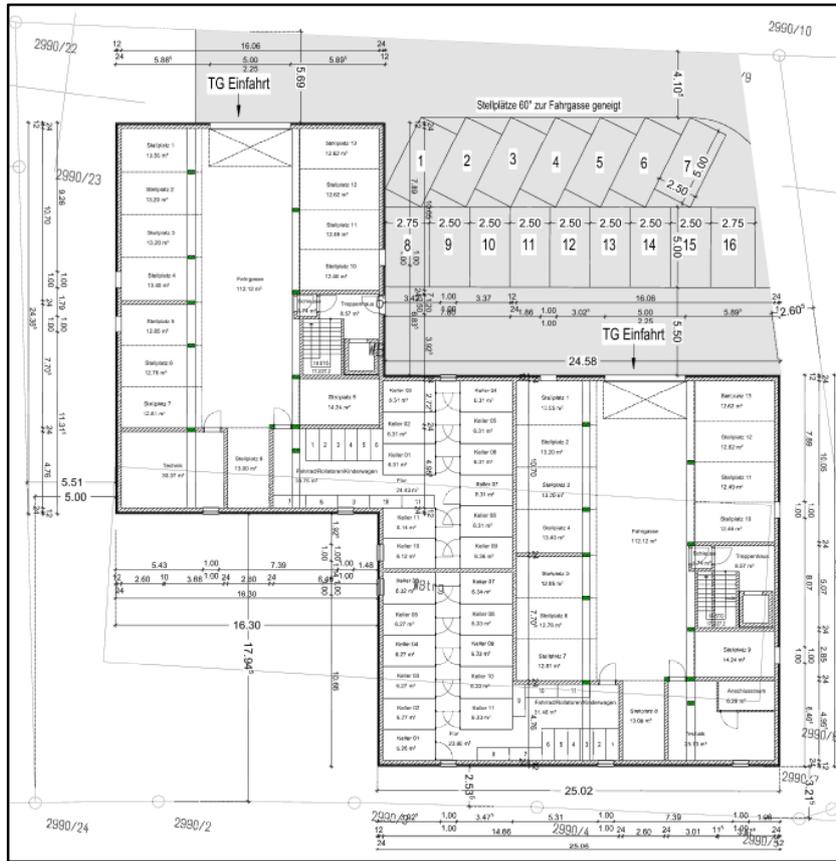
Planungskonzept Untergeschosse - Quelle: Sommer & Lauber
